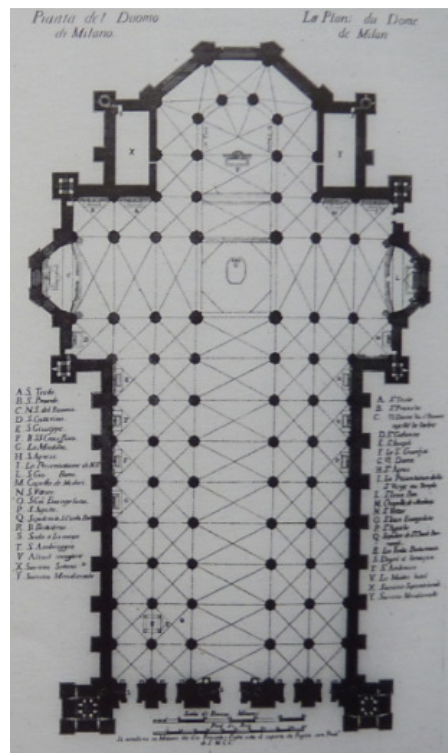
, G. Le Poer, Mailänder Dom, Grundriss, 1. H. 18. Jahrhundert, Albertina Wien.
